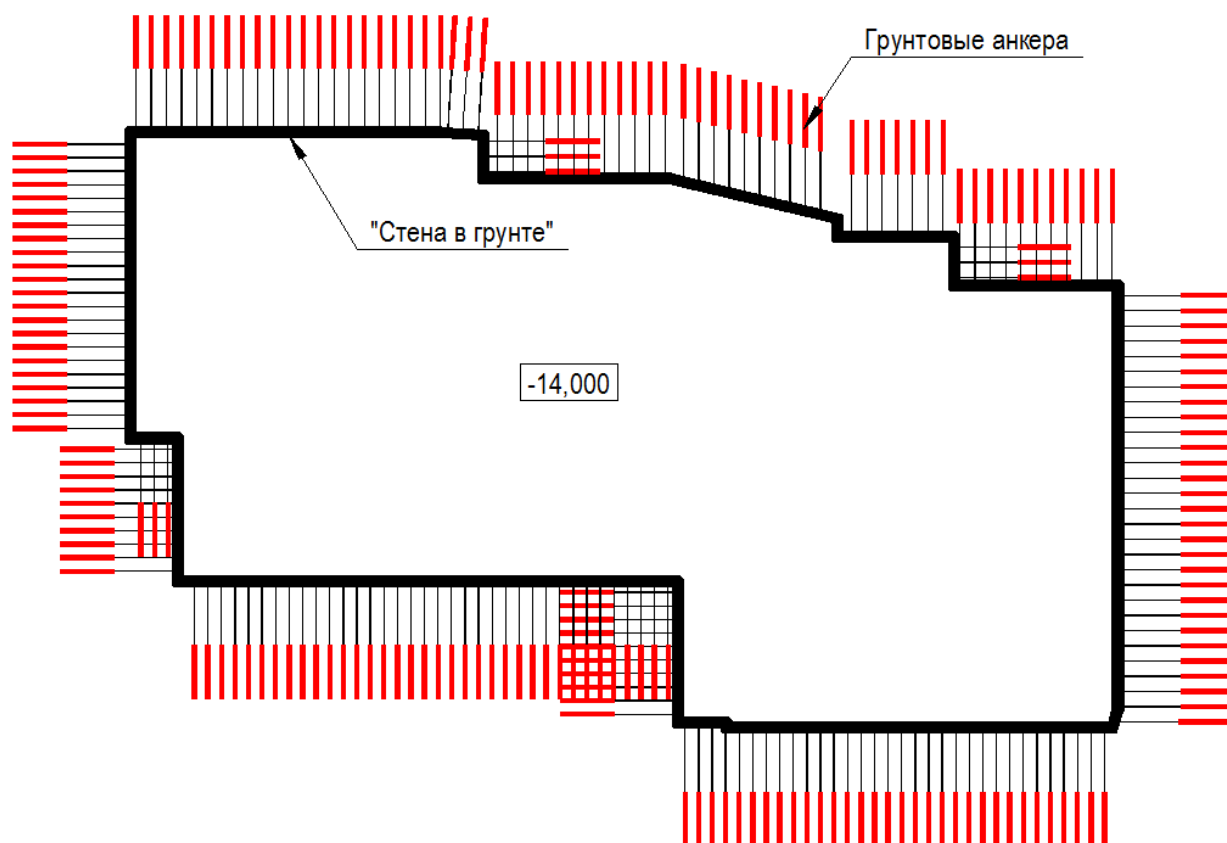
План котлована с анкерным креплением «стены в грунте»
